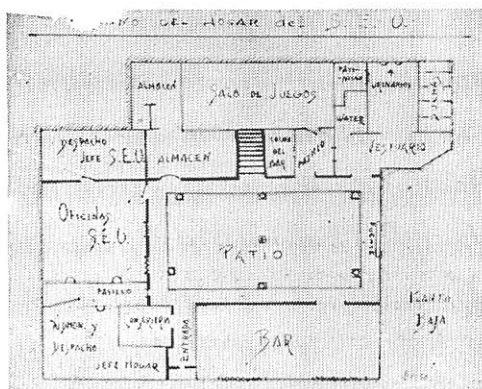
Plano del Hogar del S. E. U. Planta baja.
